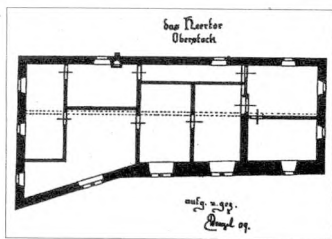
Grundriss Heertor – Oberstock.
